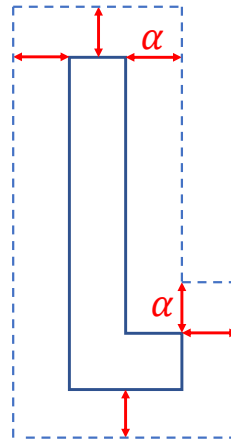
Tolerancia  $\alpha$  para la ubicación de un muro en planta
